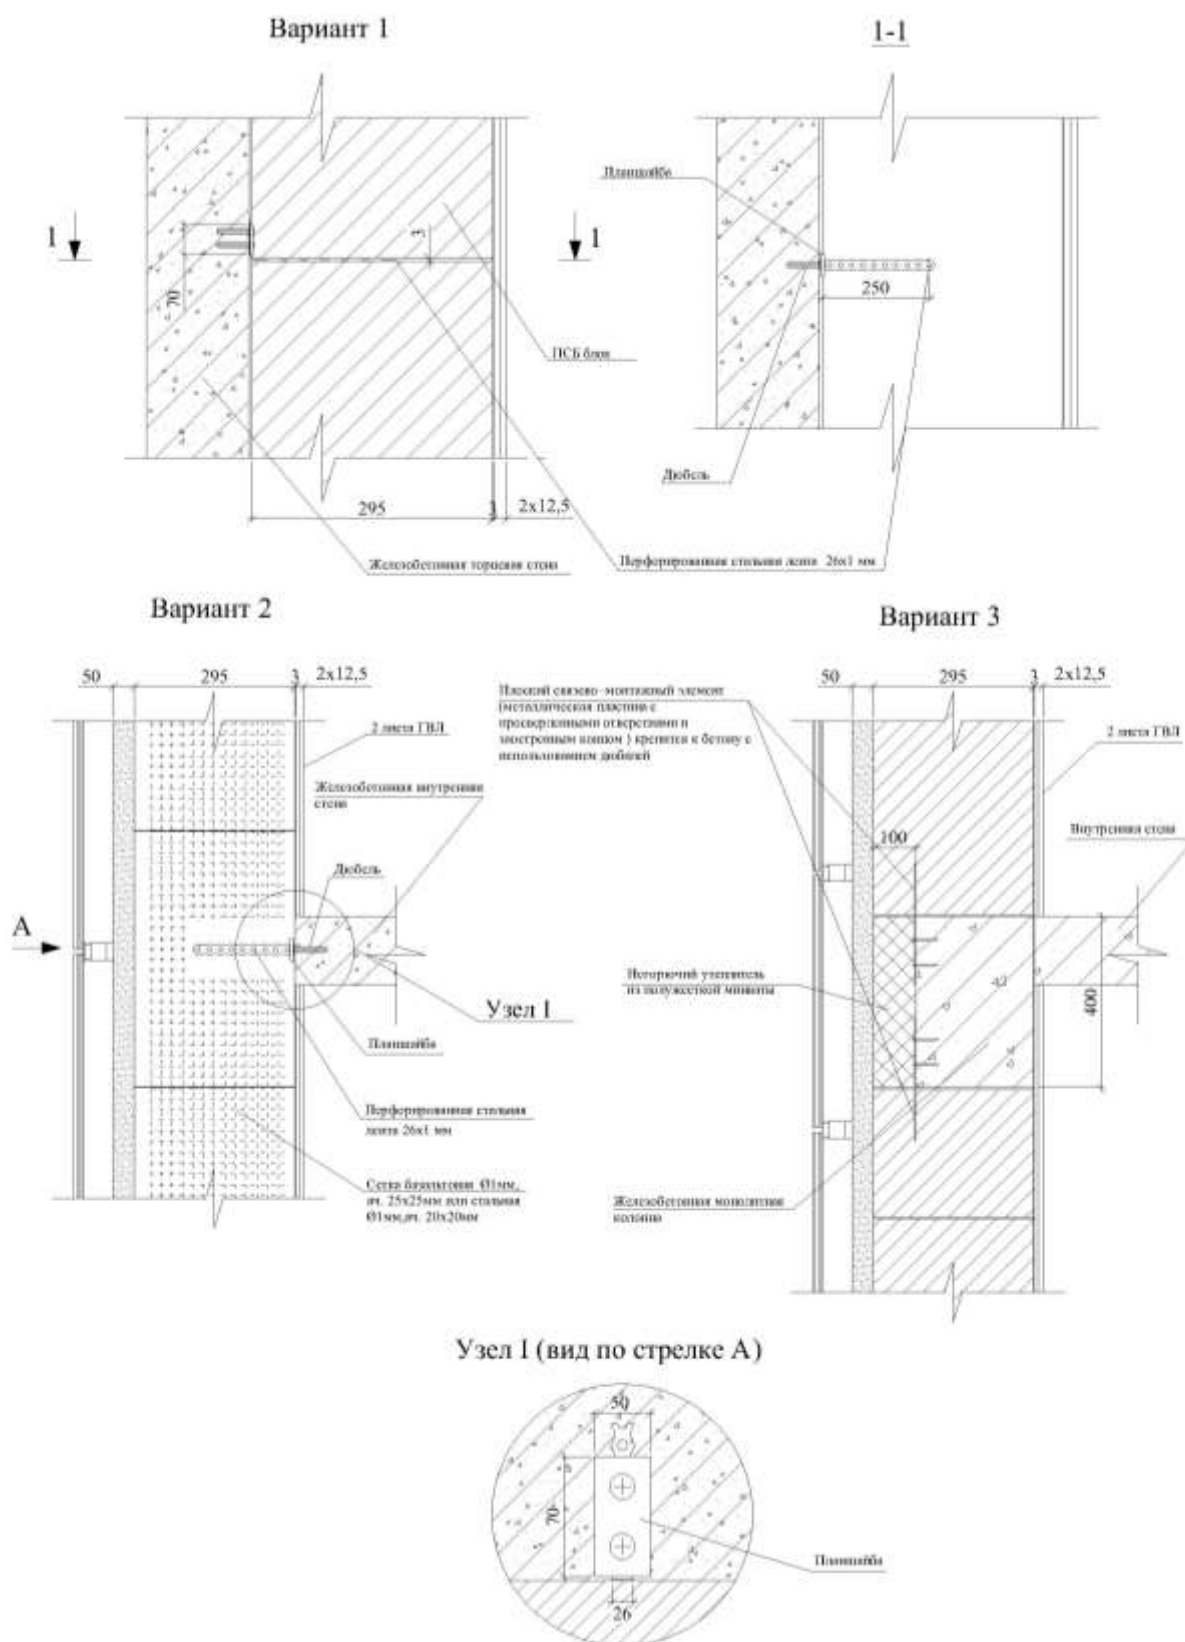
Крепление кладки из ПСБ блоков к несущим железобетонным стенам и колоннам
